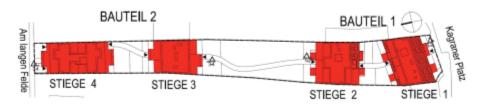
Lageplan der Gebäude – BVH1¹²⁰
